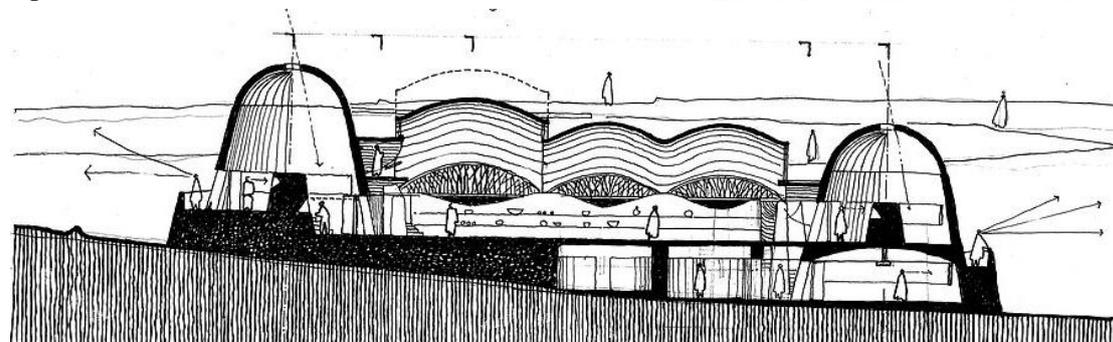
Corte longitudinal. Fonte: <https://www.peterrichitects.com/mapungubwe-interpretation-centre>
